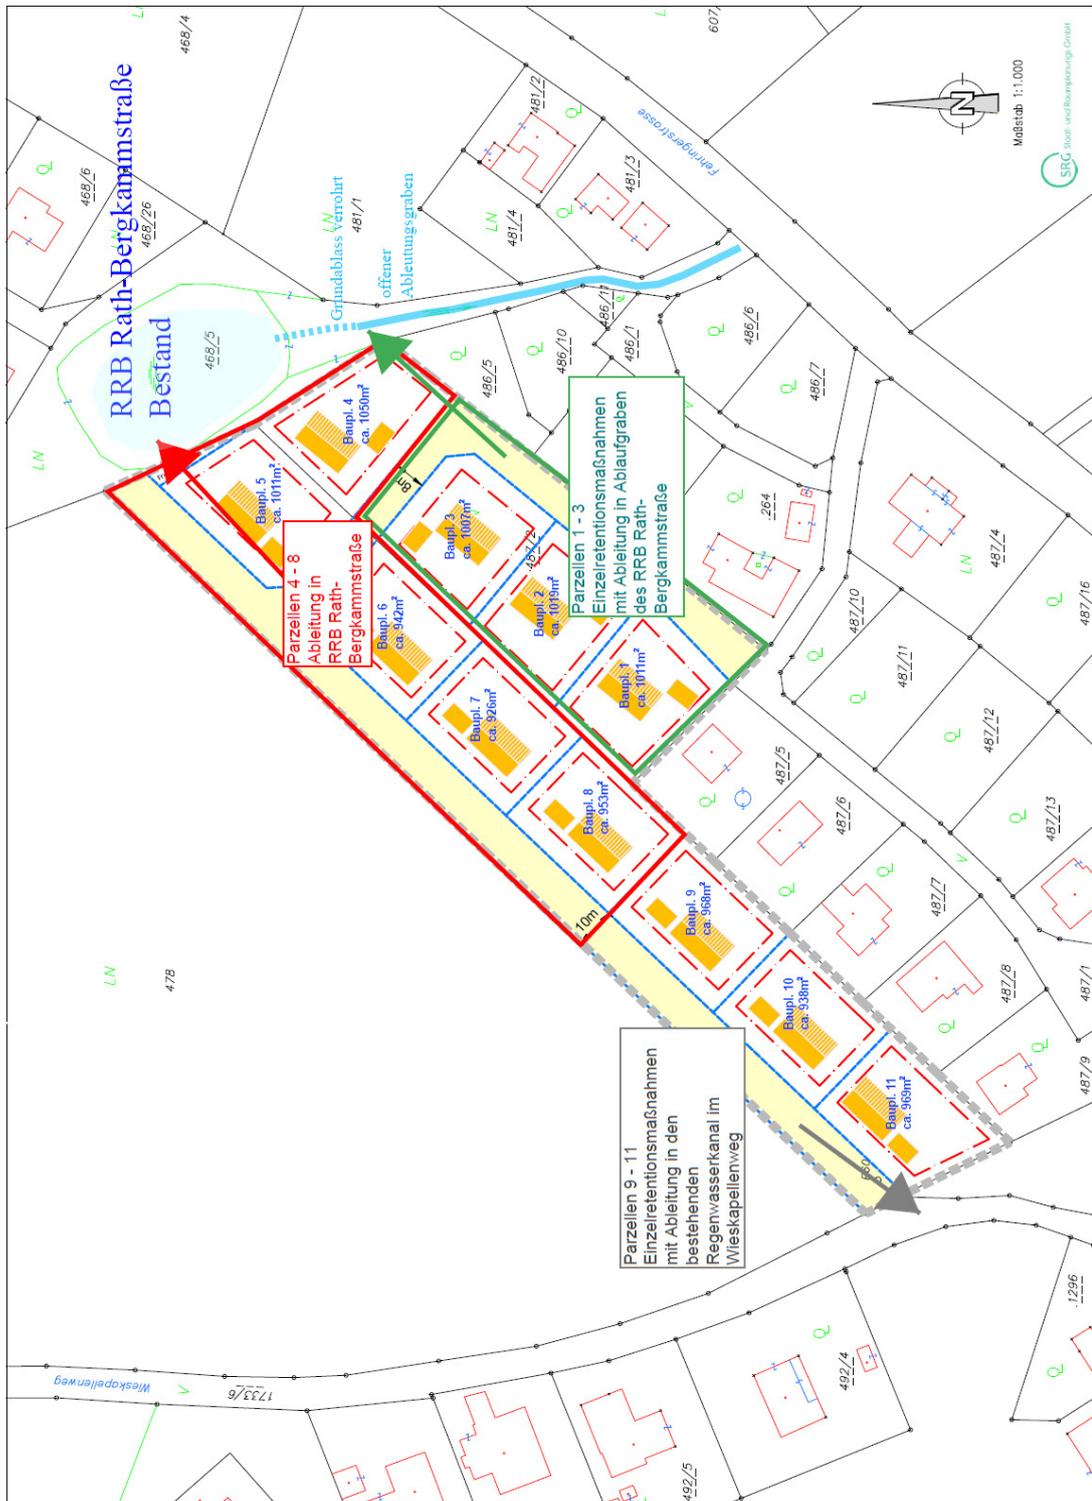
Lageplan Regenwasserbewirtschaftungskonzept
